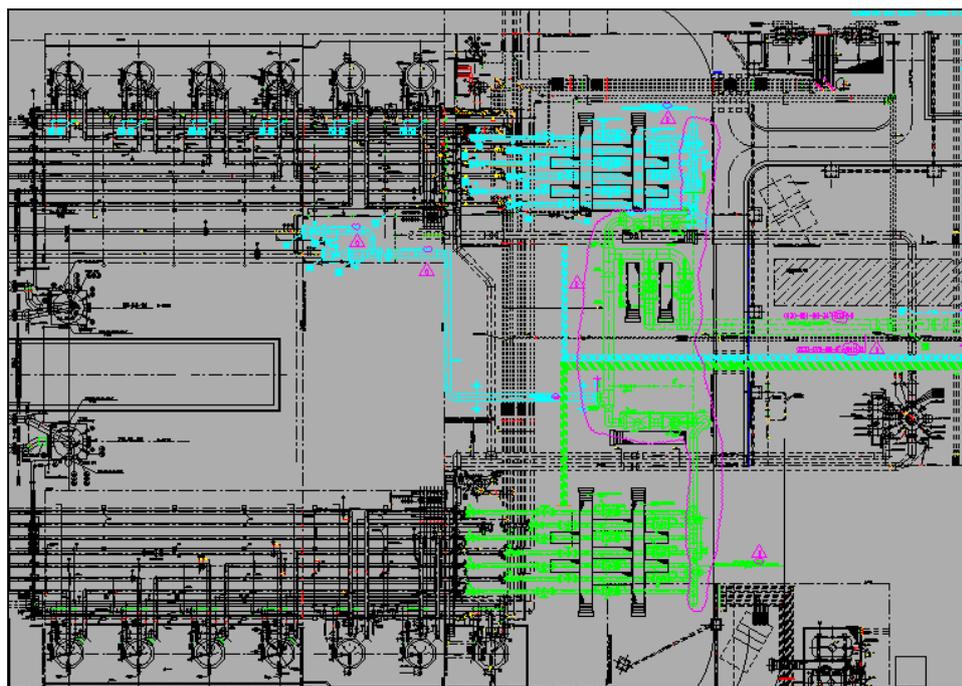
Planimetria Tie-ins di Centrale – Fase 1 + Fase 2 (in ciano nuove installazioni Fase 2, in verde nuove installazioni Fase 1)
